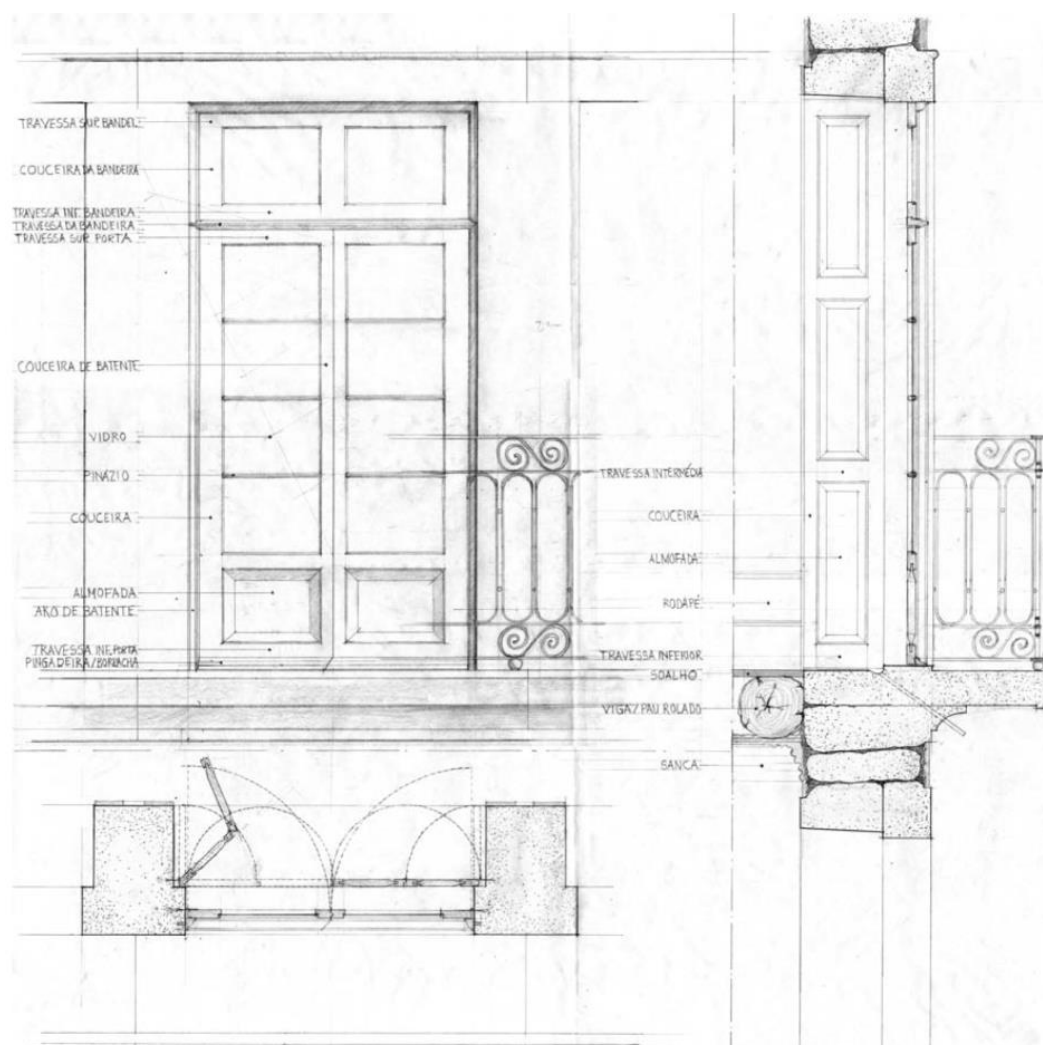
Alçado, planta e corte tipo de janela de batente de sacada. Fonte: Teixeira, 2004.
